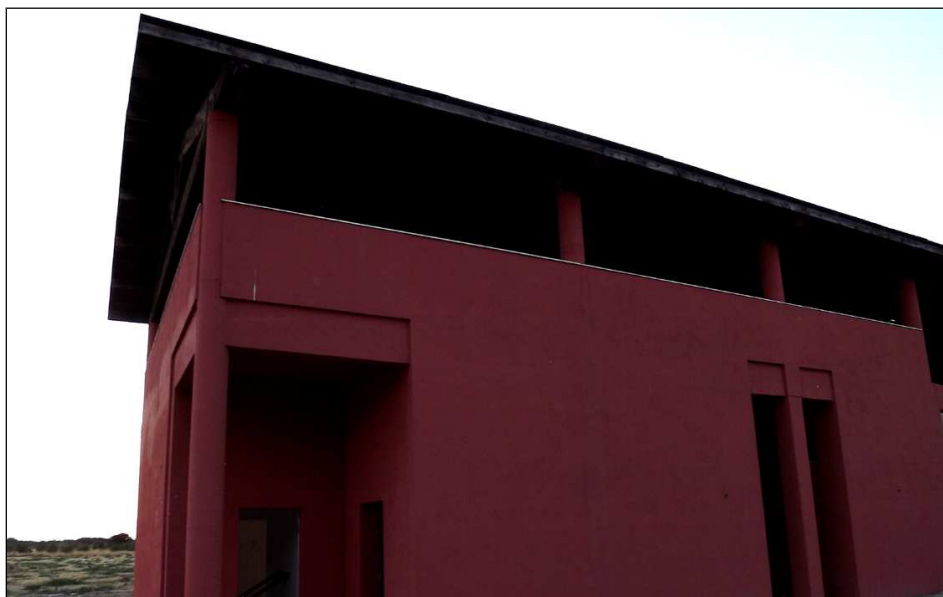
vista dall'esterno del terrazzo dove realizzare il bat-roost
